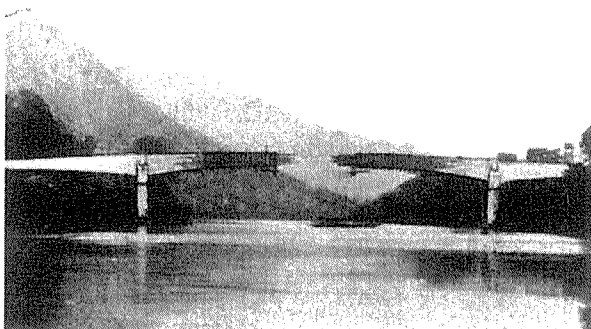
RC橋の張出し施工 (ブラジル, 1930年)
